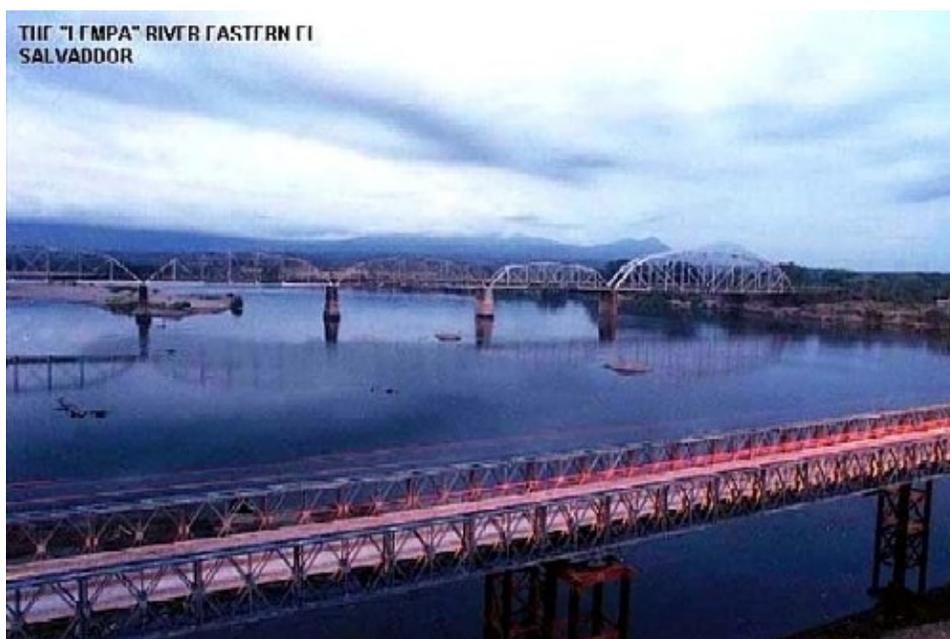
Puente de provisional Bailey sobre el río Lempa carretera CA-2 en San Marcos Lempa. Al fondo el puente del ferrocarril, paso antiguo hecho con armaduras metálicas poligonales.
